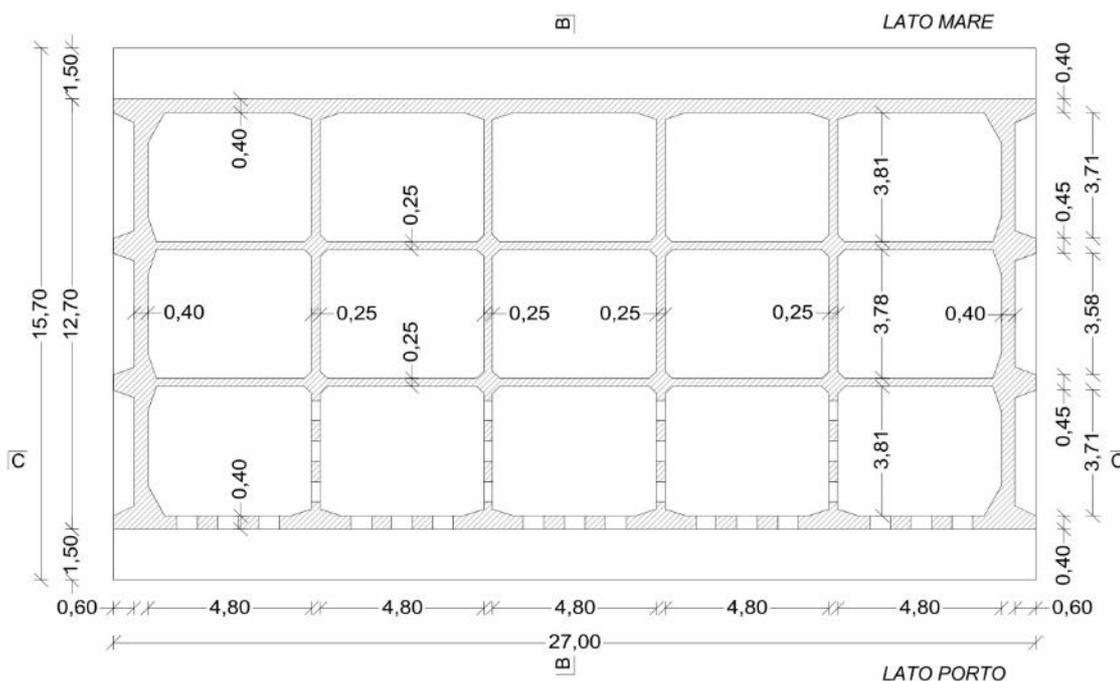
Cassoni tipo 1: Carpenteria - Pianta (Sezione orizzontale A-A)
